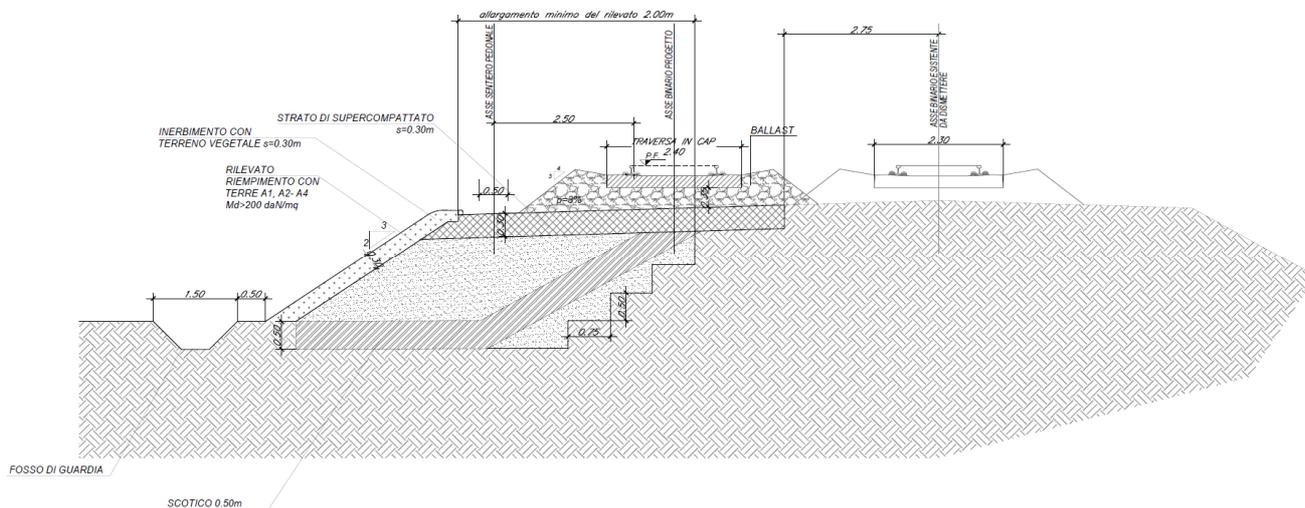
Sezione tipo in rilevato Variante Provvisoria alla Linea Storica, tratto in ammorsamento al corpo stradale esistente
